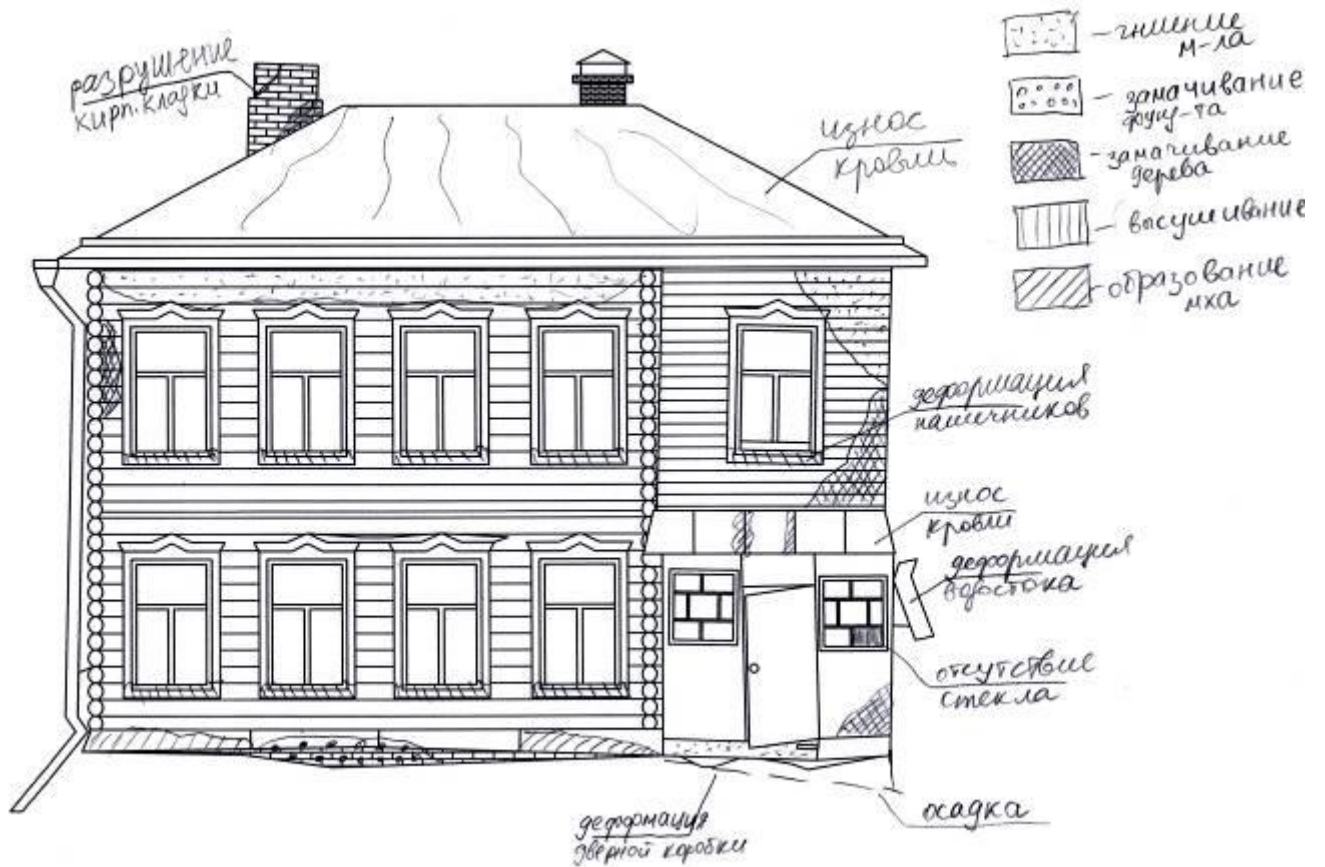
Дефектная карта фасада деревянного здания (пример)
